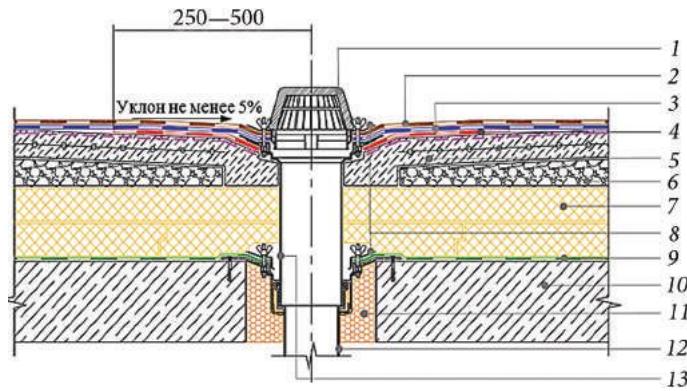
Воронка внутреннего водостока: 1 — листвоуловитель; 2 — верхний слой кровельного покрытия; 3 — нижний слой кровельного покрытия; 4 — слой усиления из кровельного материала; 5 — цементно-песчаная стяжка; 6 — уклонообразующий слой; 7 — утеплитель (например TECHNORUF 45); 8 — прижимной фланец; 9 — пароизоляция; 10 — железобетонная плита перекрытия; 11 — монтажная пена; 12 — водоприемная воронка; 13 — надставной элемент
